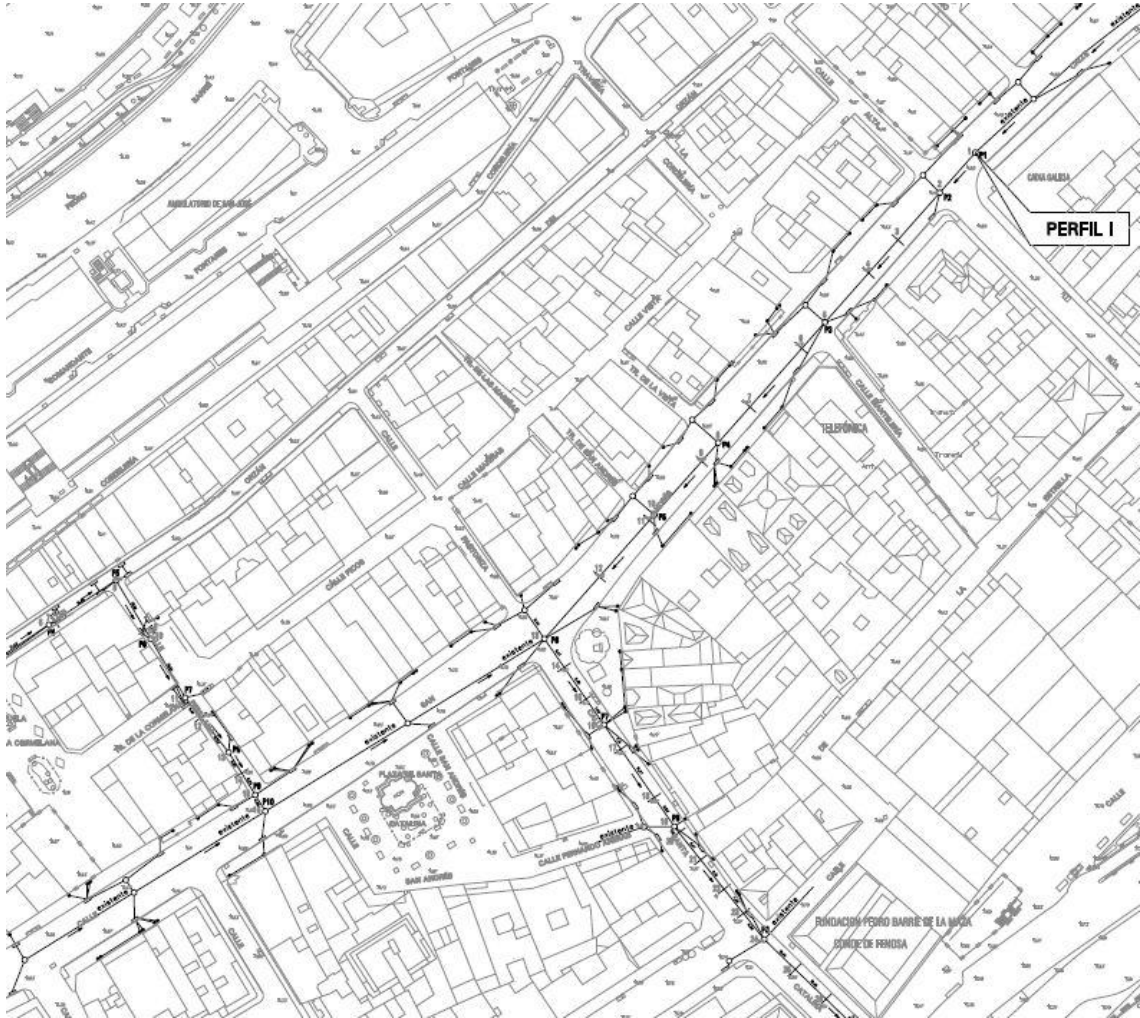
Plano de la distribución general del sistema de saneamiento.
